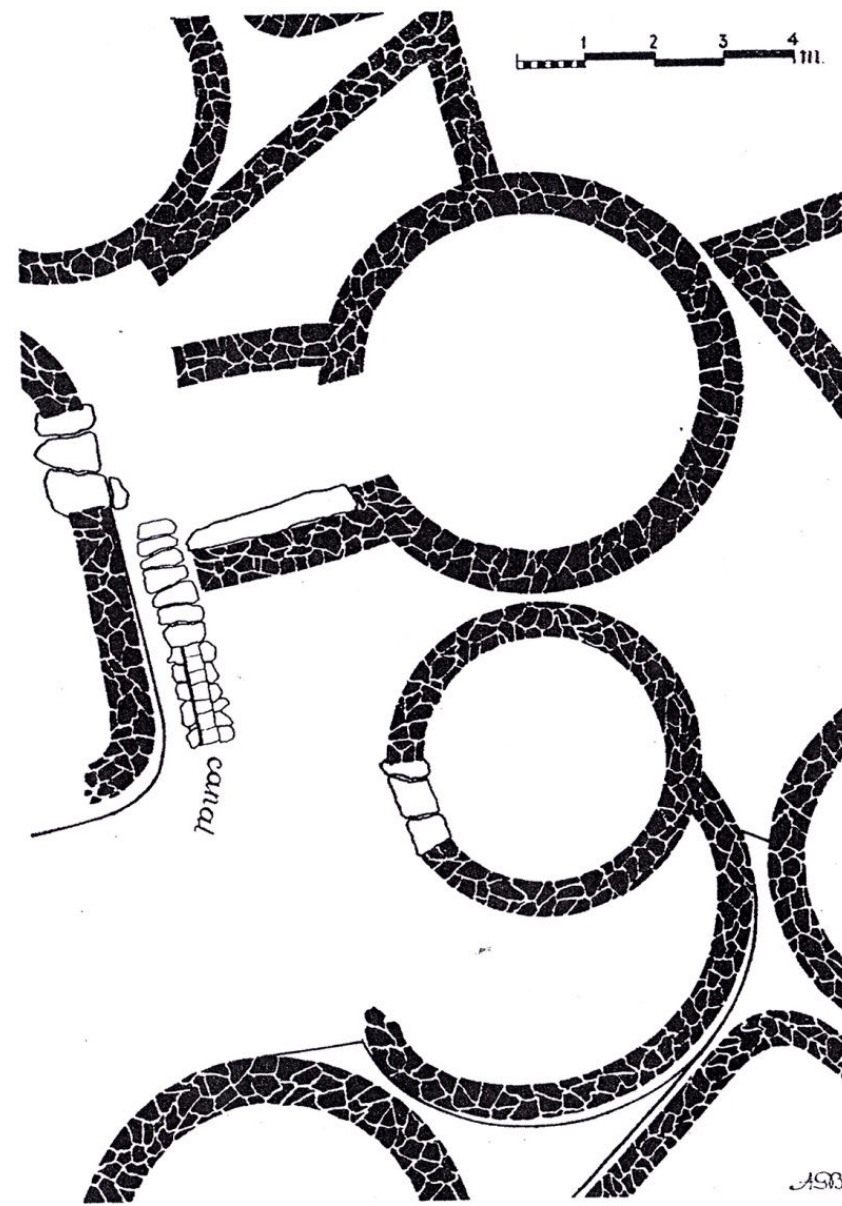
Planta de un conjunto de cabañas en el Castro de Coaña. Destaca un canal construido con lajas de pizarra que discurre entre las viviendas. Plano realizado por D. Antonio García y Bellido. carácter indígena, hallazgos cerámicos y hallazgos de origen exótico.
